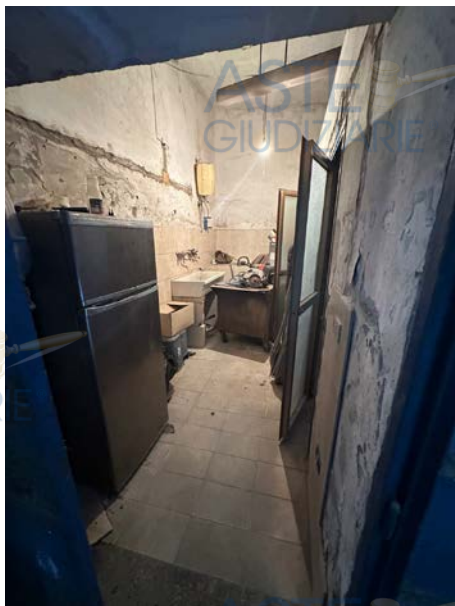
Locale spogliatoio accessibile dal secondo corpo di fabbrica
